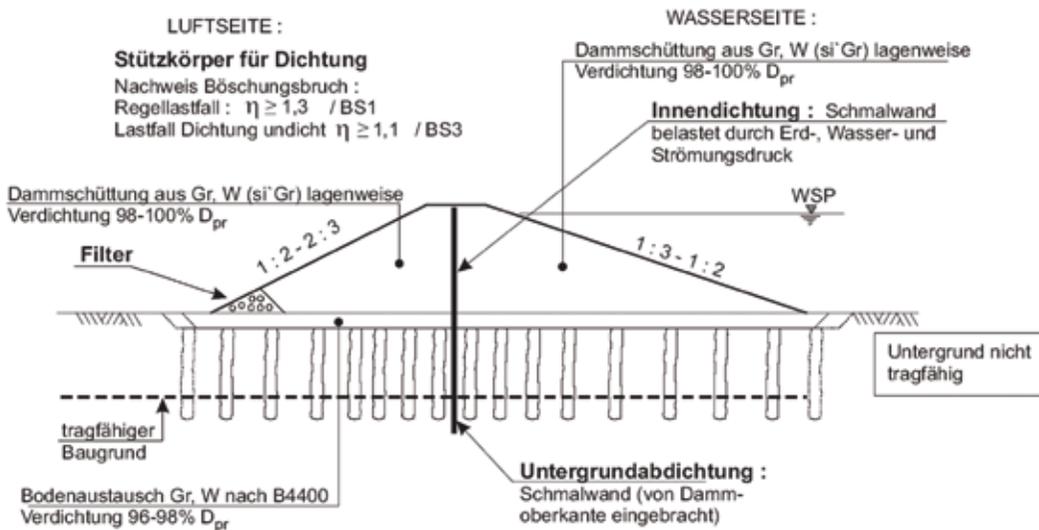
Bautyp – Damm auf nicht tragfähigem Untergrund mit Innen- und Untergrundabdichtung mittels Schmalwand
